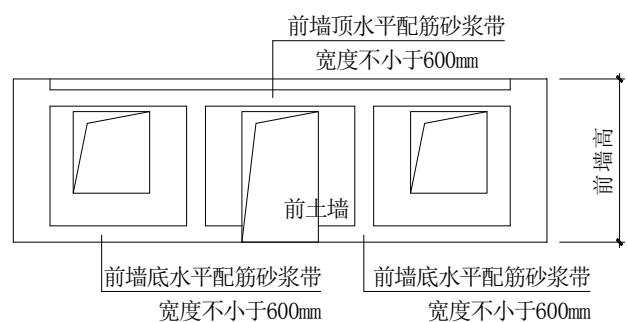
三间房前墙水平配筋砂浆带的布置示意图
